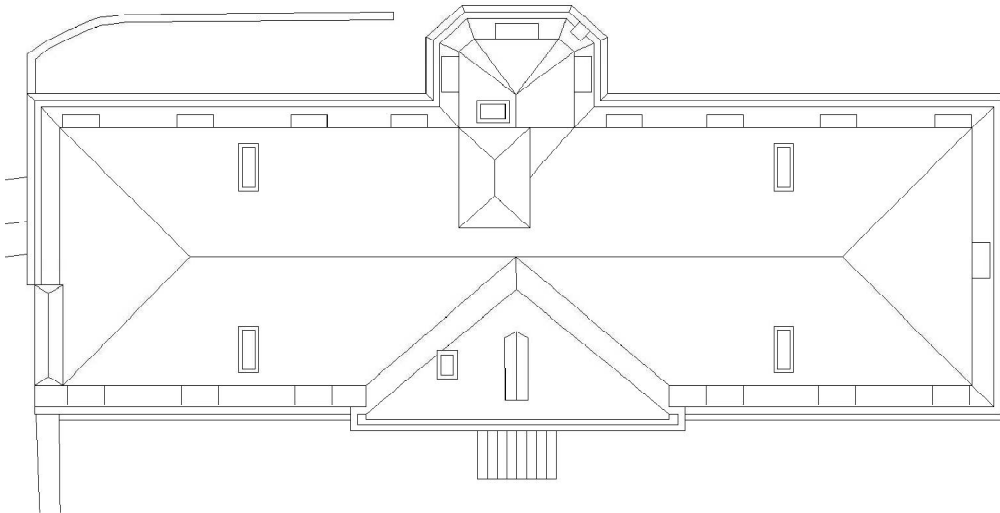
Planta de Cobertura, retirada do levantamento arquitetónico (TOPOMETRIA, 1998).
